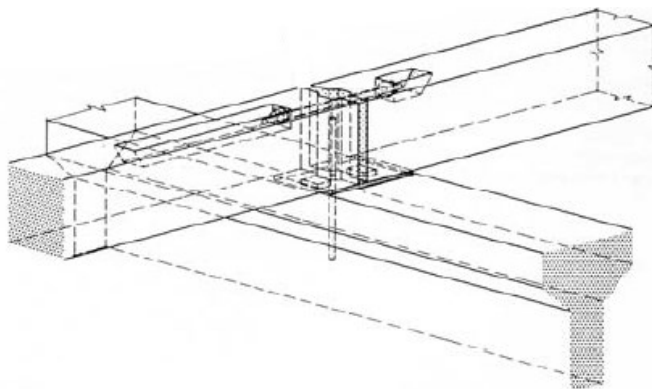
Ligação viga principal – viga secundária através de barras pré-esforçadas (STUPRÉ, 1981).
